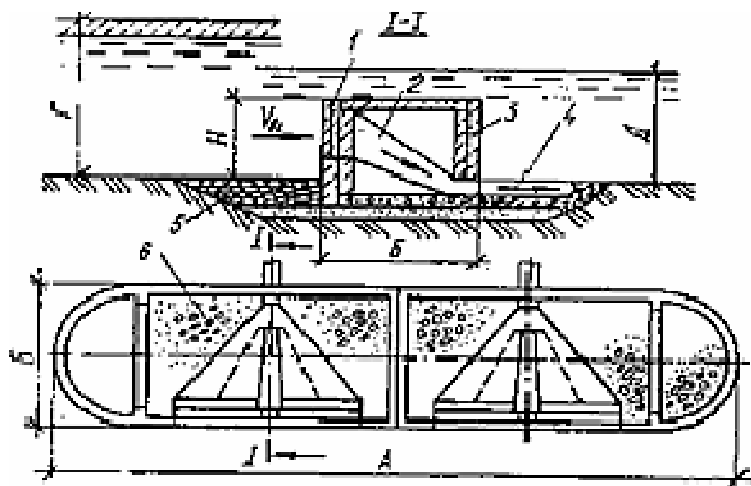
Железобетонный раструбный защищенный оголовок с боковым приемом воды:
